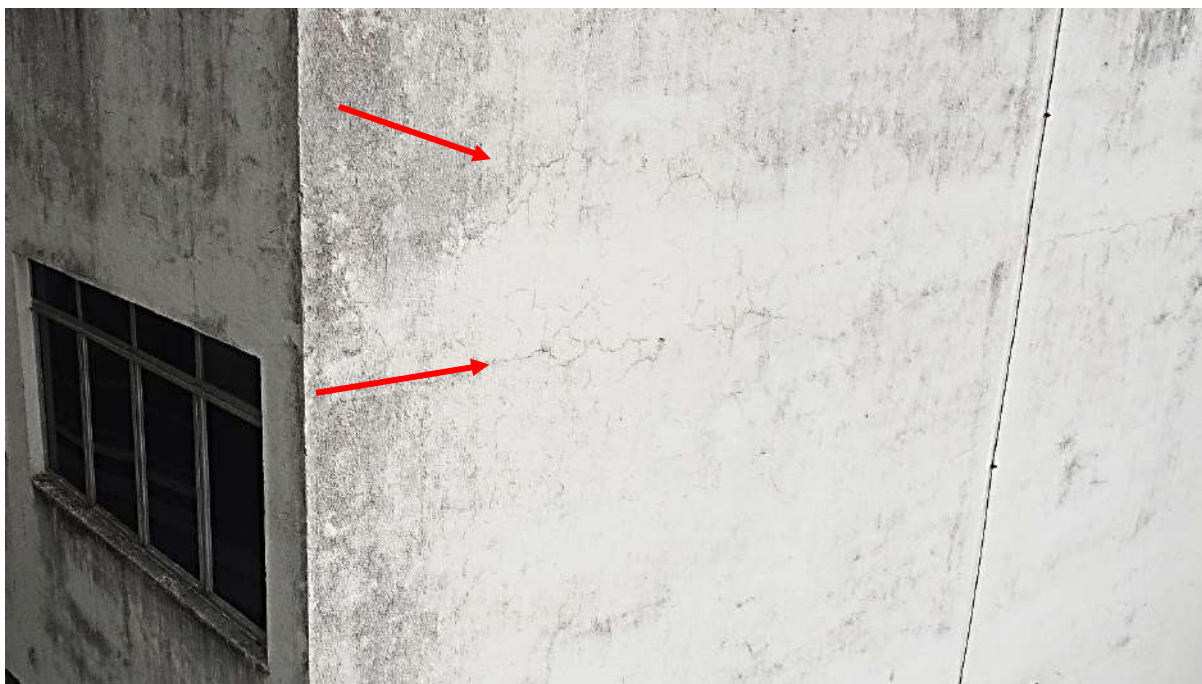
Vista da fachada leste, que apresenta fissuras mapeadas.
